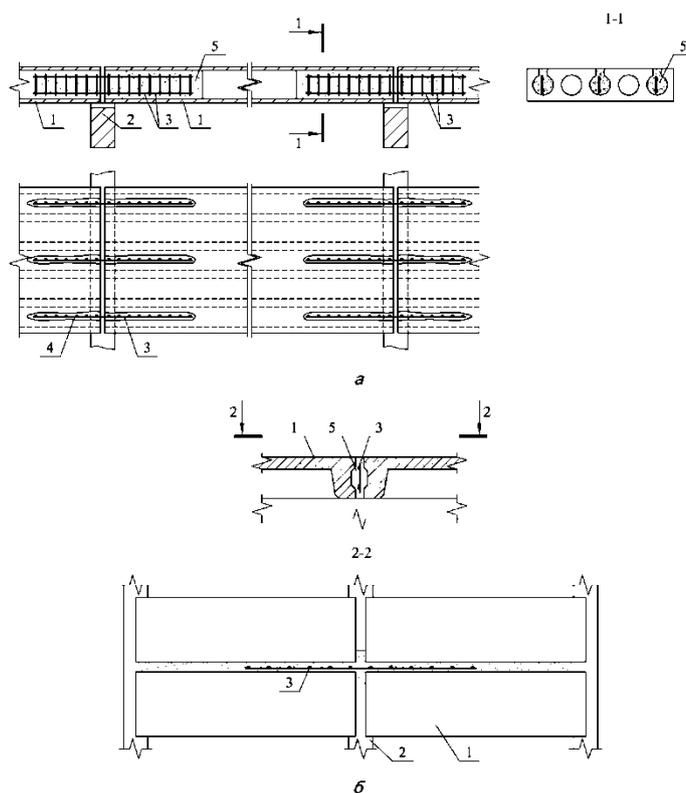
Усиление конструкций обеспечением их неразрезности: а – при бетонировании пустот многопустотных плит; б – при бетонировании расширенных швов между плитами; 1 – усиливаемые плиты; 2 – ригель; 3 – арматурный каркас; 4 – отверстия в полках плит; 5 – бетон
